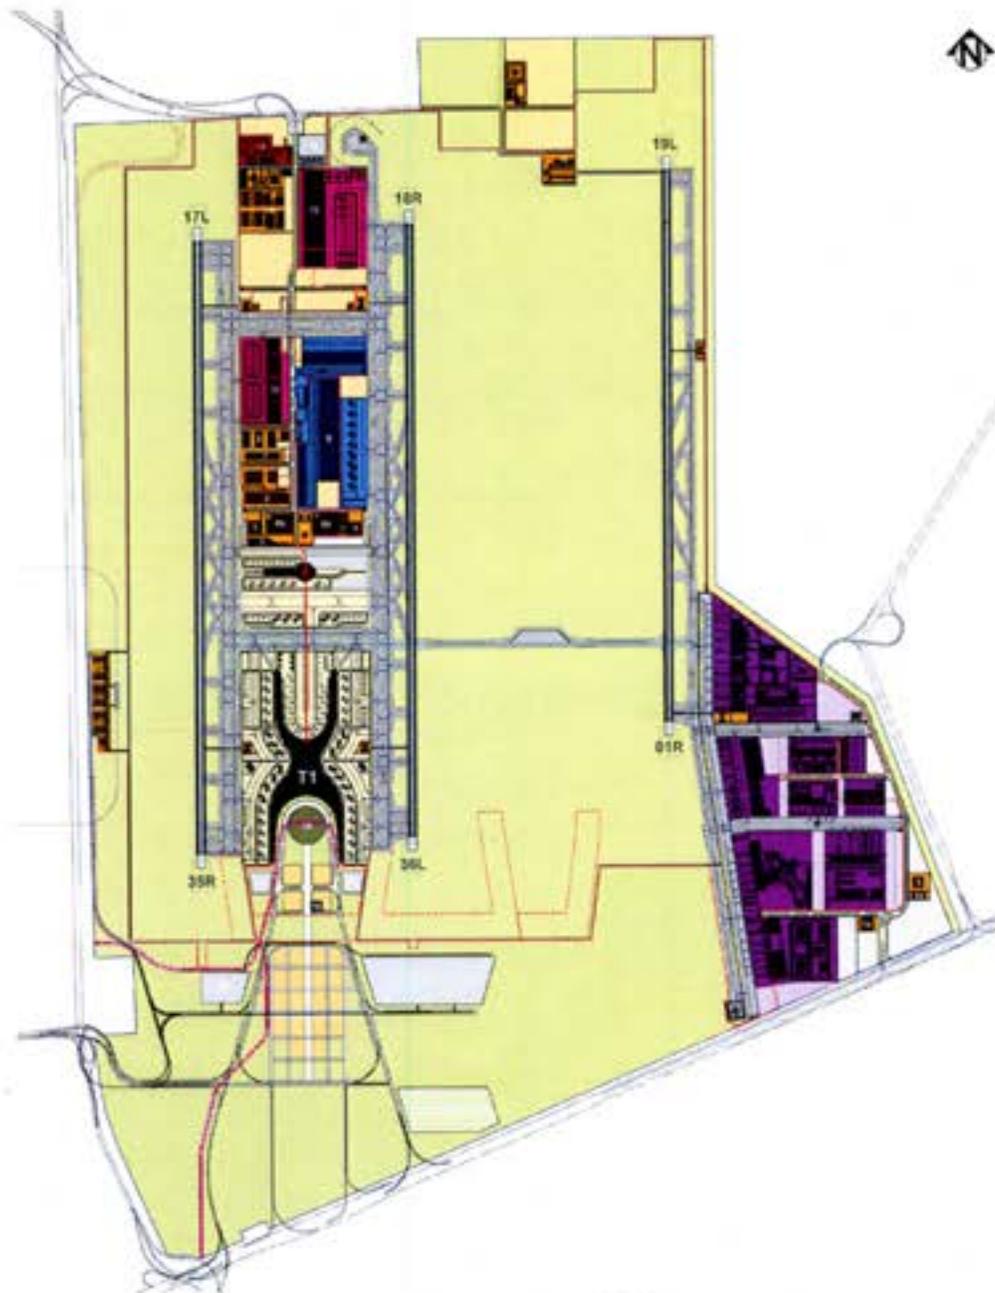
Esquema del Aeropuerto | Plan Maestro 2030
